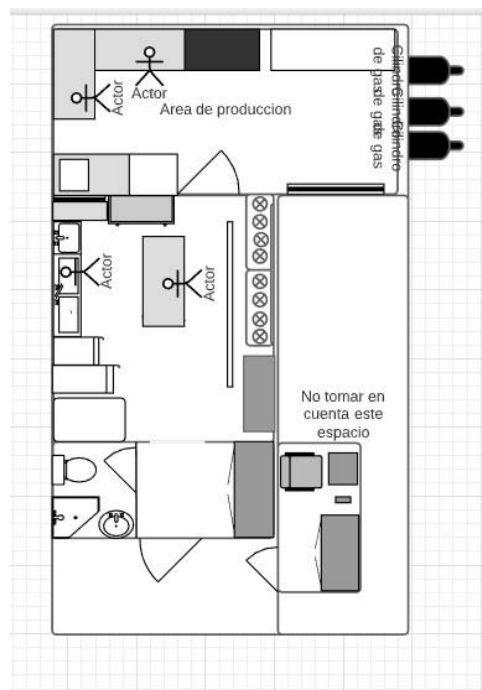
Ramírez. (2020). Plano arquitectónico del establecimiento.
